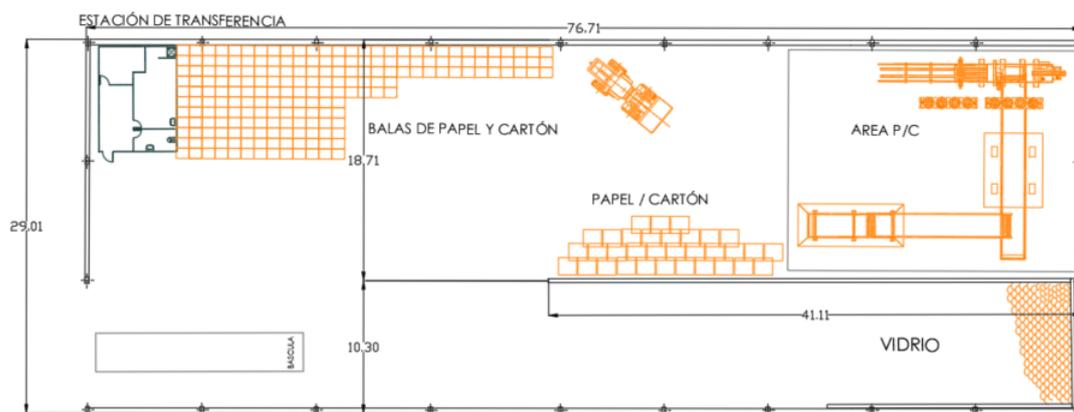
Planta general propuesta de estación de transferencia alternativa n^o2
